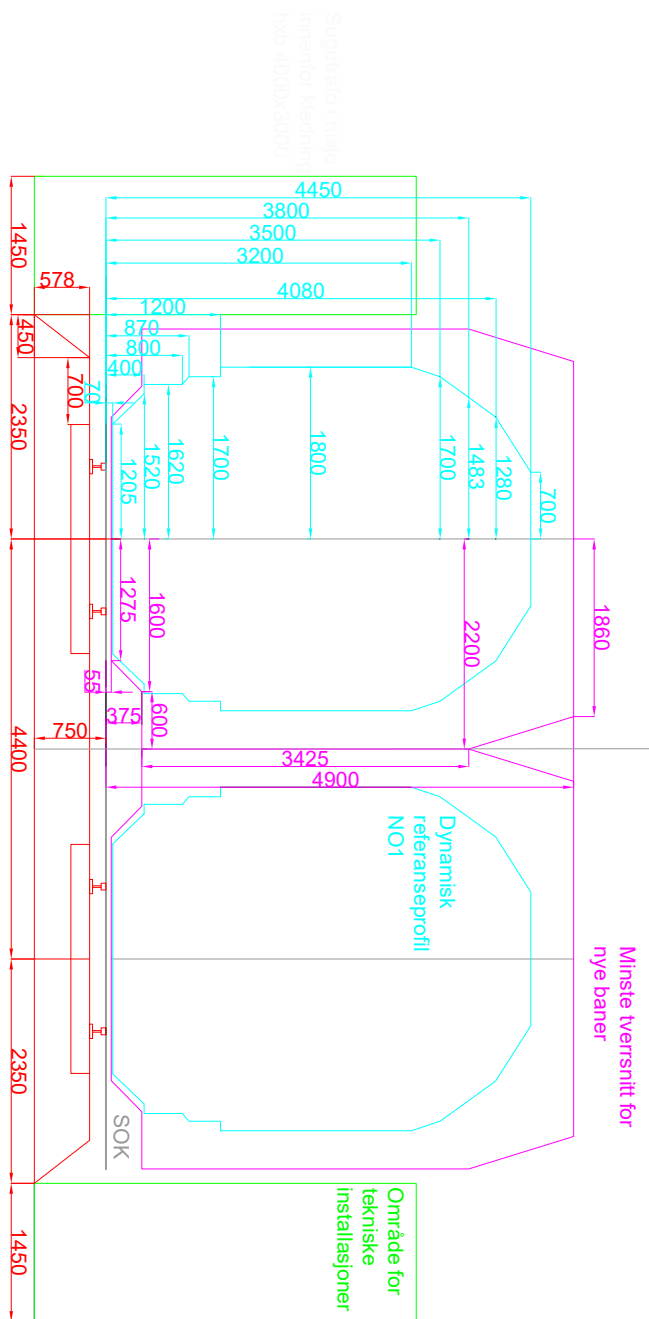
Detaljtegning sporkonstruksjon Bekkedalshøgda tunnel
